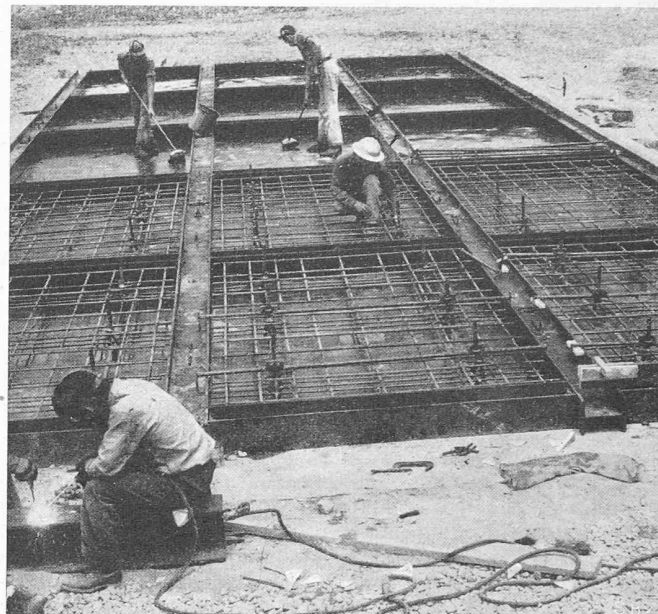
Herstellung vorgegossener, armierter Betonplatten für die Bekleidung der wasserseitigen Oberfläche
